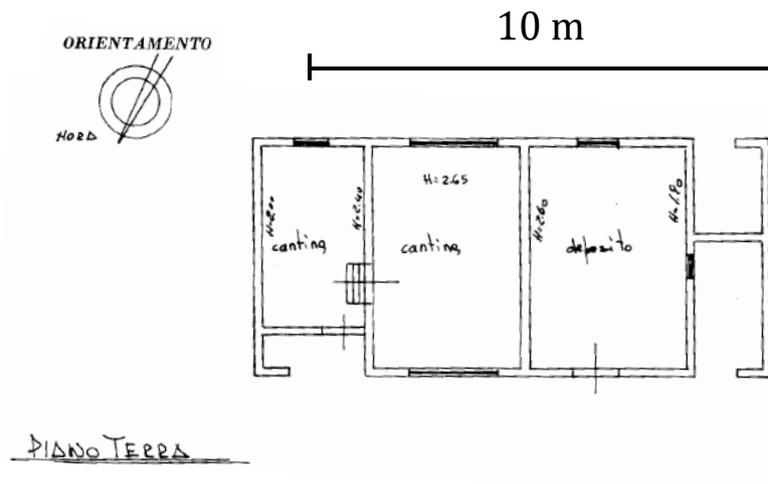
Estratto Planimetria Catastale - Abitazione di tipo civile NCEU Foglio 20, part 201
